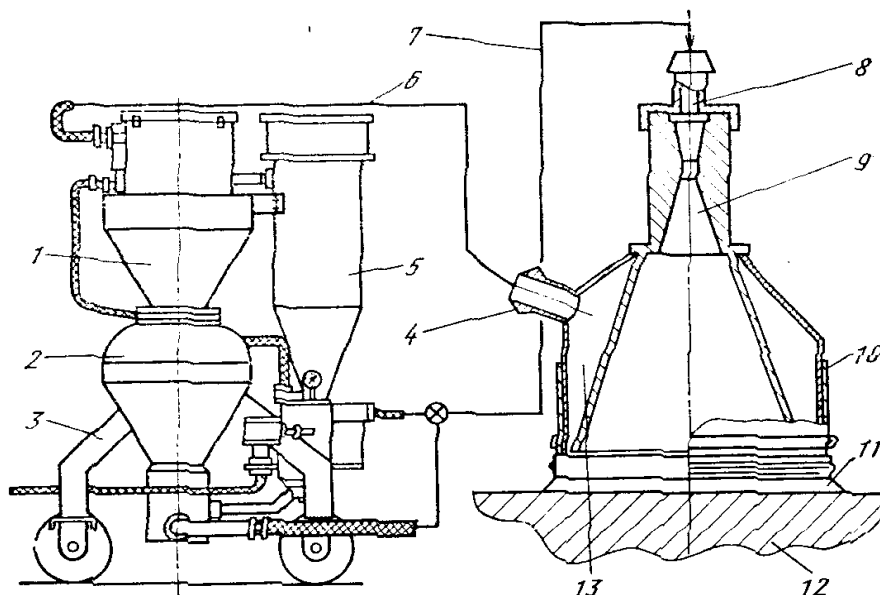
Схема пневмодинамической установки БДУ-Э2М
